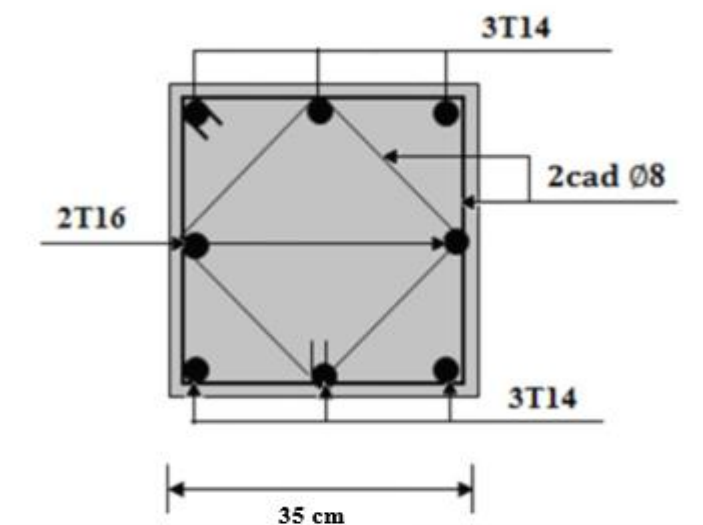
Schéma de ferrailage des poteaux (35×35) cm.
